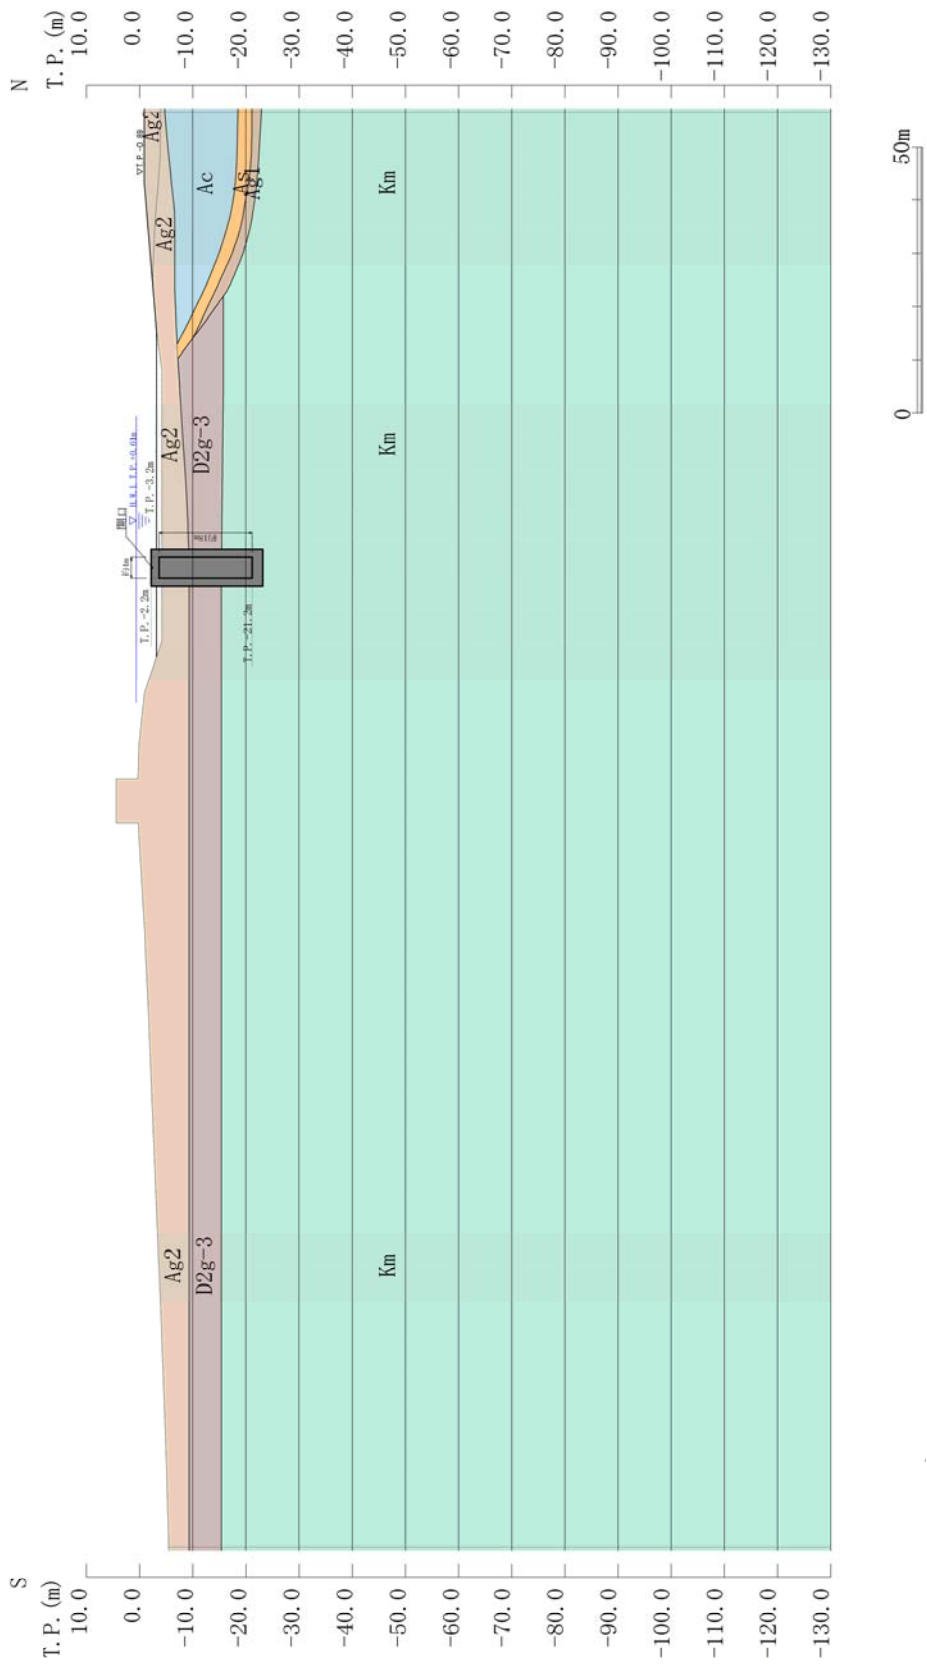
(4) SA用海水ピット取水塔 評価対象断面図 (②-②断面)
